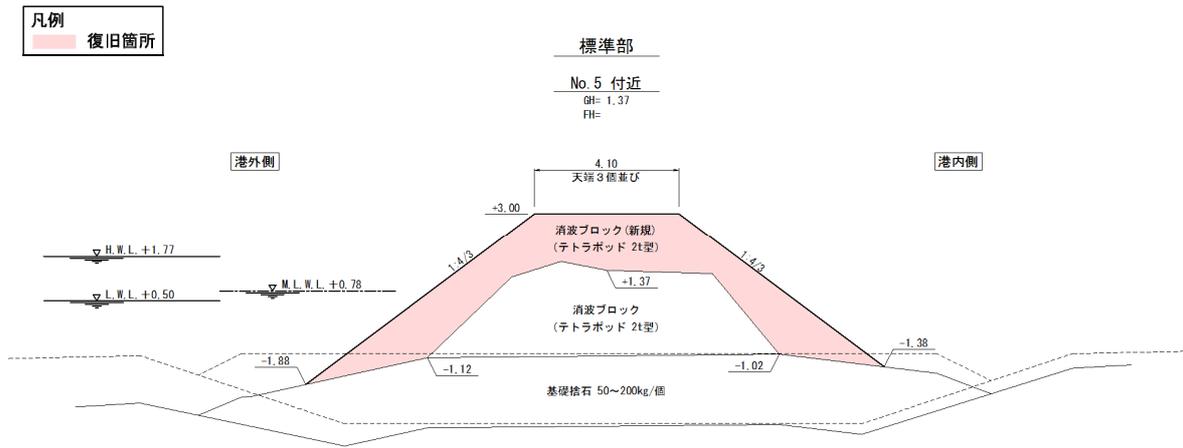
塩釜港区\_代ヶ崎離岸堤の断面図 (復旧後)
